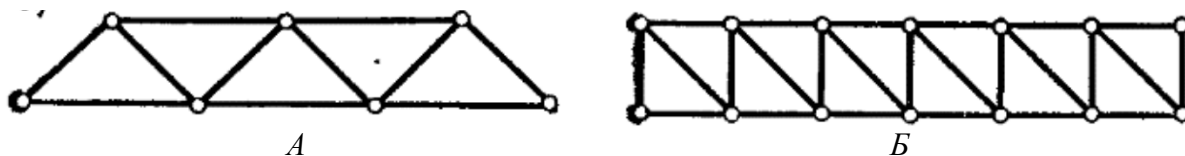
Схемы ферм с типами решётки: А – треугольной, Б – раскосной
